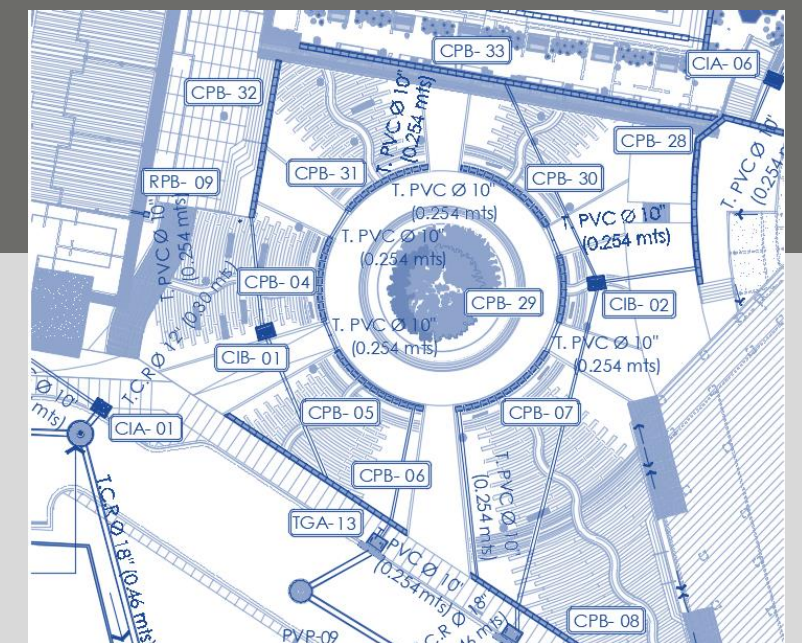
Segmento de red de distribución de drenaje pluvial, zona plaza secundaria. Ver lámina en anexo N°12.
